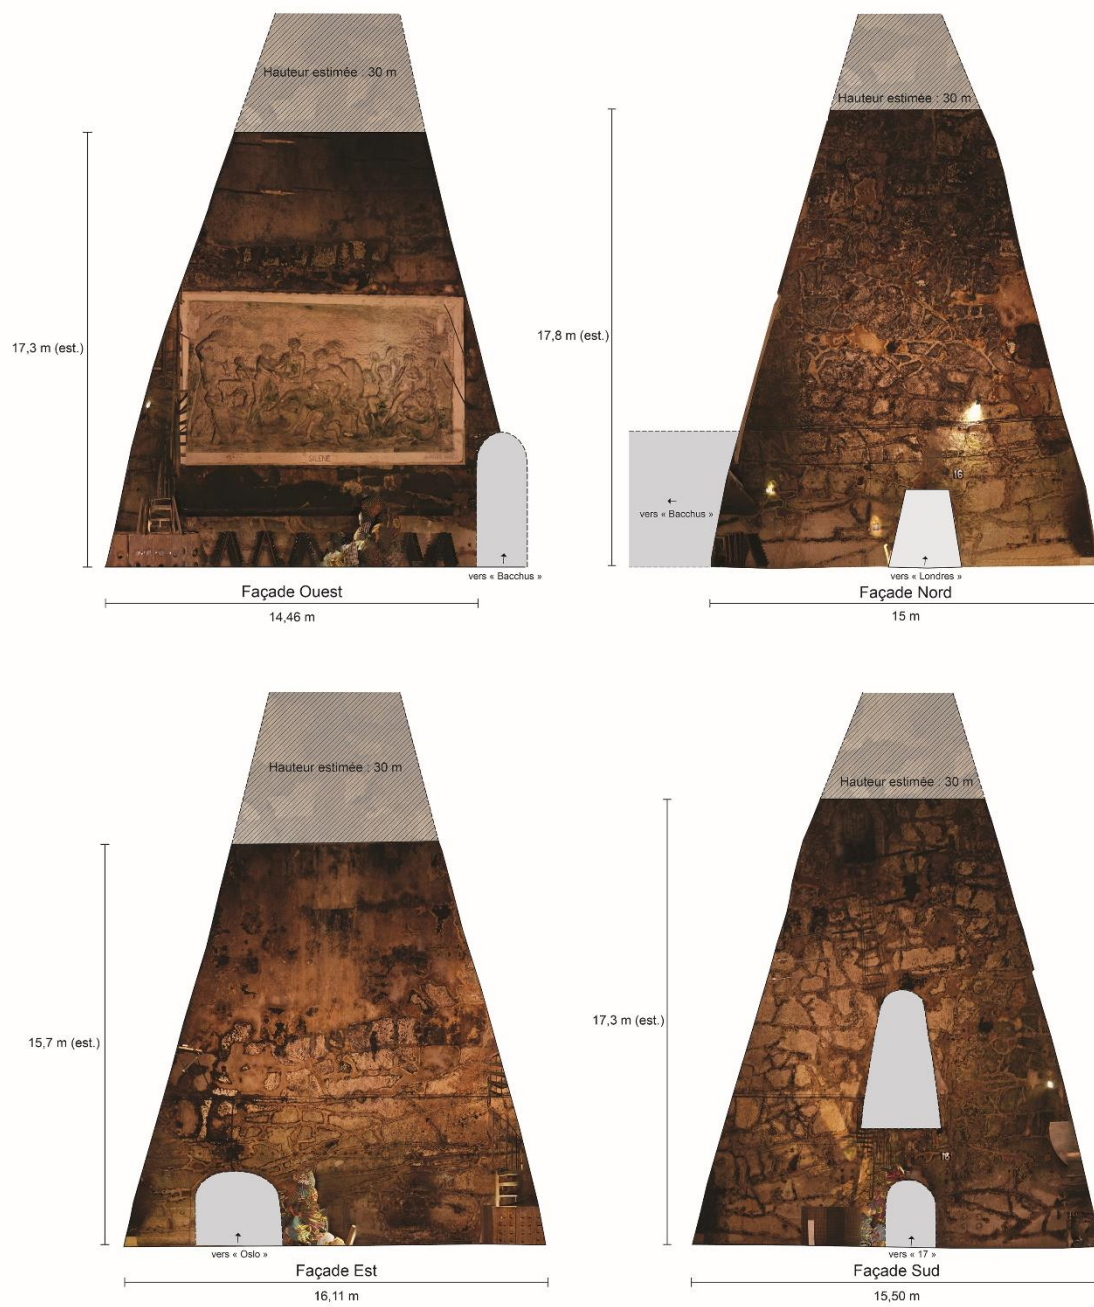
Plan des façades de la cave 16 dite « Silène »
